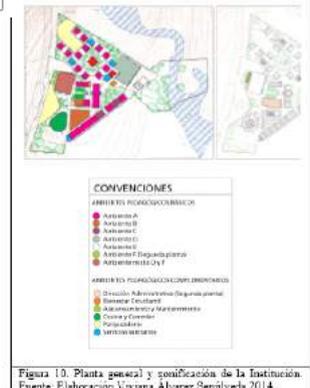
Planta general y zonificación de la Institución. Fuente: Elaboración Viviana Álvarez Sepúlveda 2014
